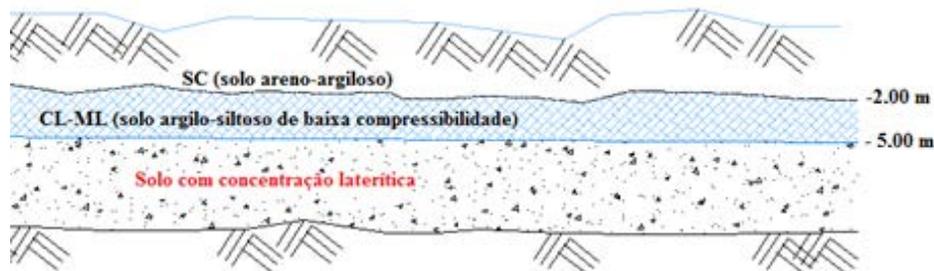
Perfil geotécnico do subsolo do aterro sanitário de Boa Vista/RR.
